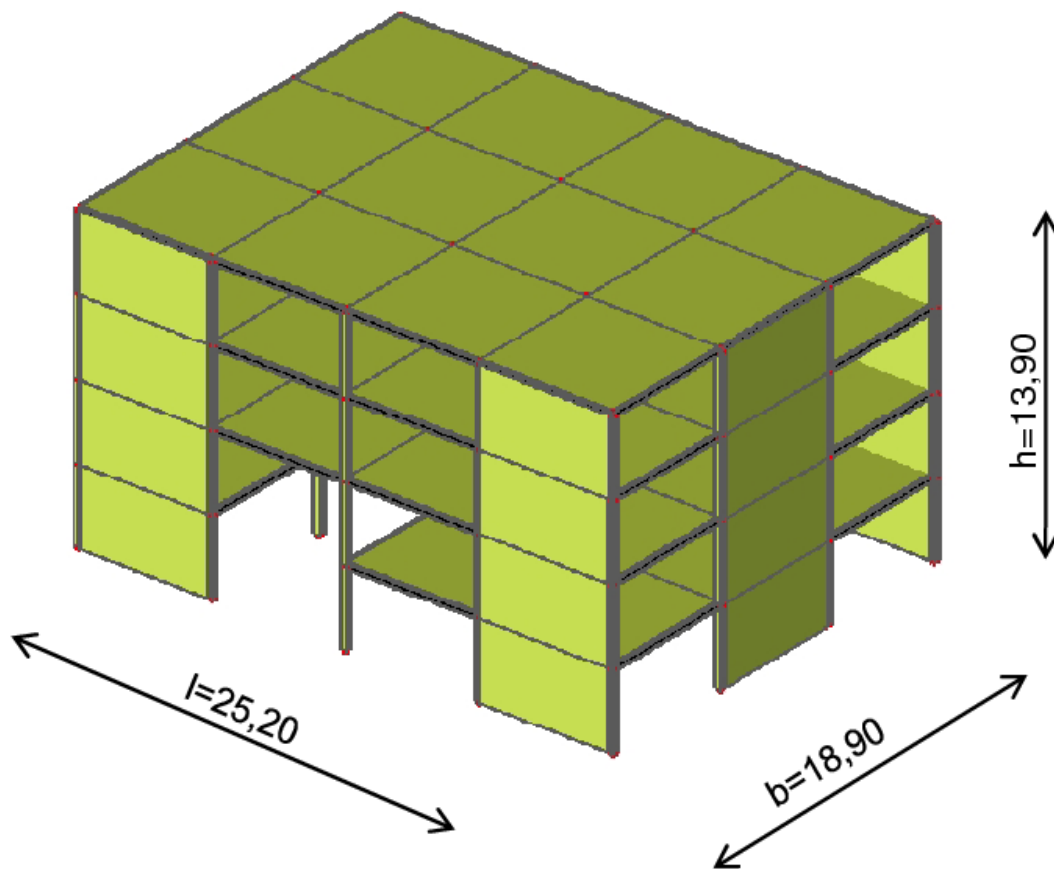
Stahlgebäude mit Mauerwerksausfachung.
